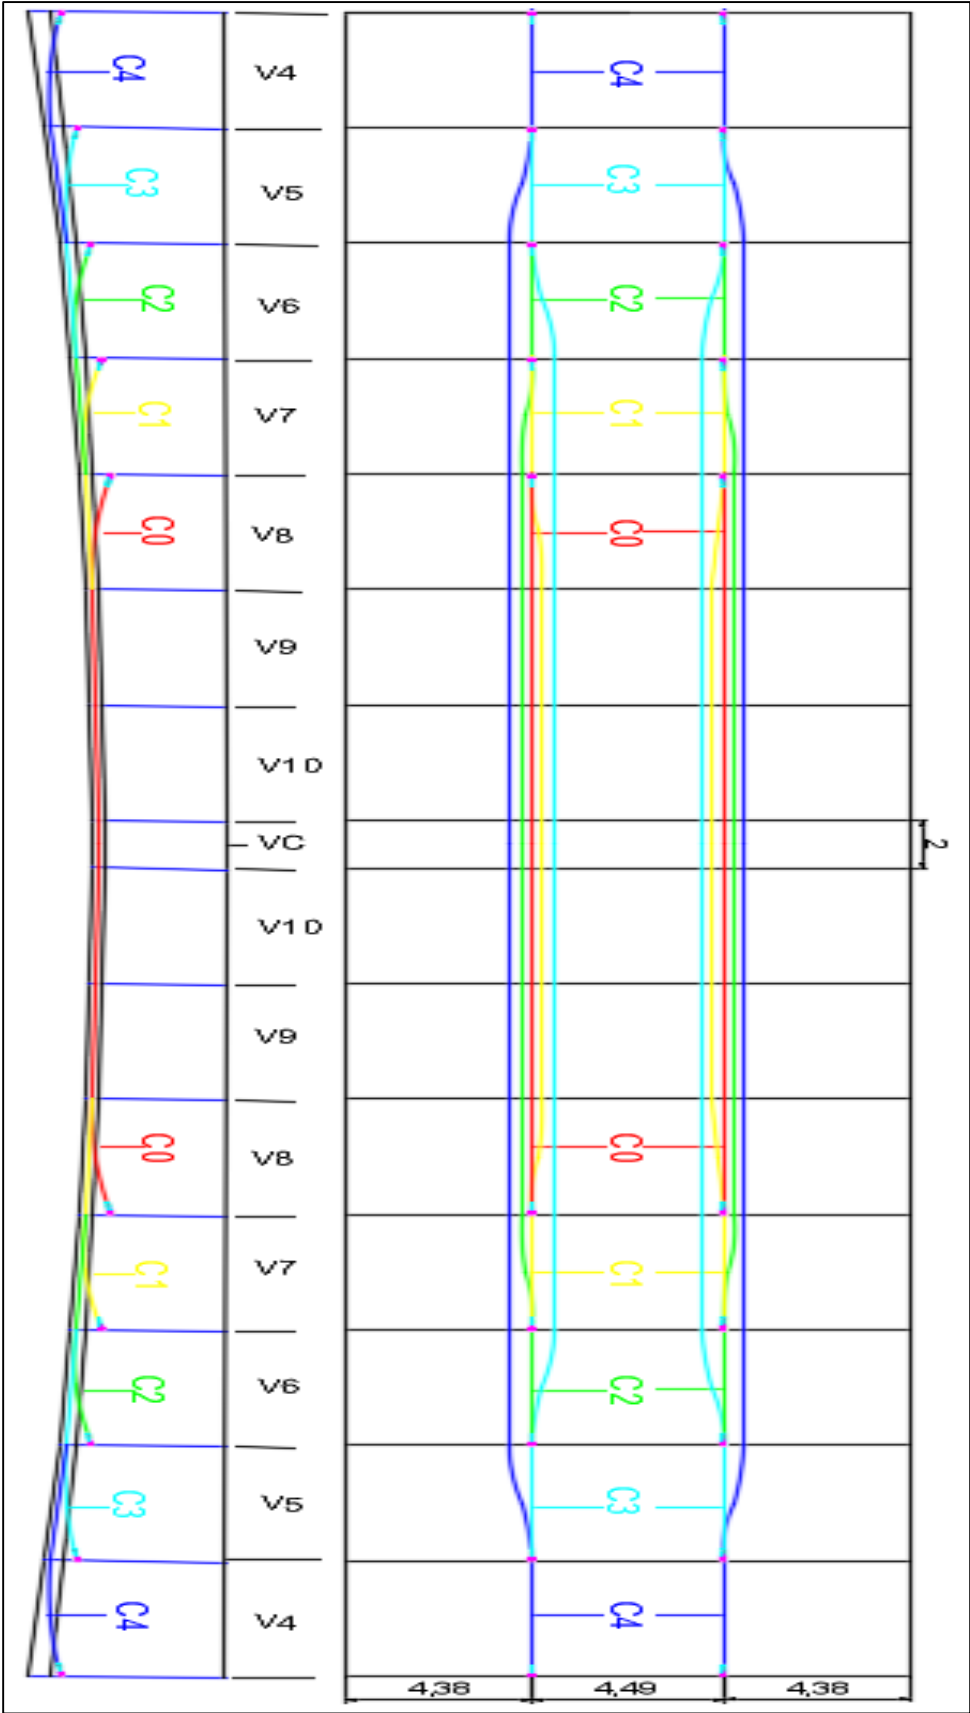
Tracé en élévation et en plan des câbles de continuité de travée principale.
